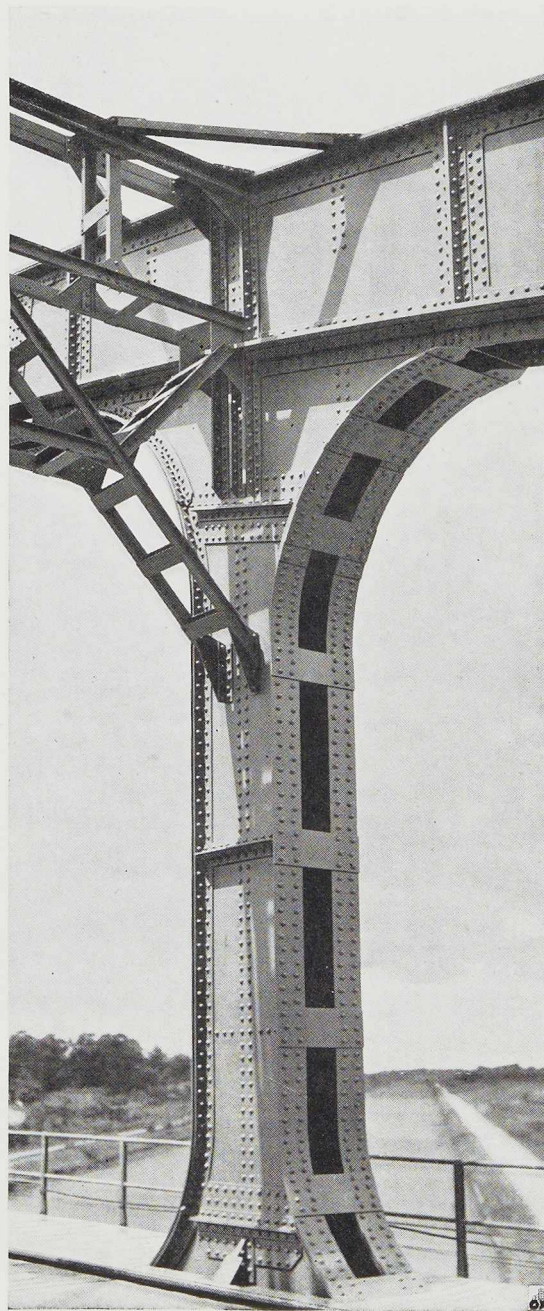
Vue d'un montant avec le raccord du contreventement supérieur.
